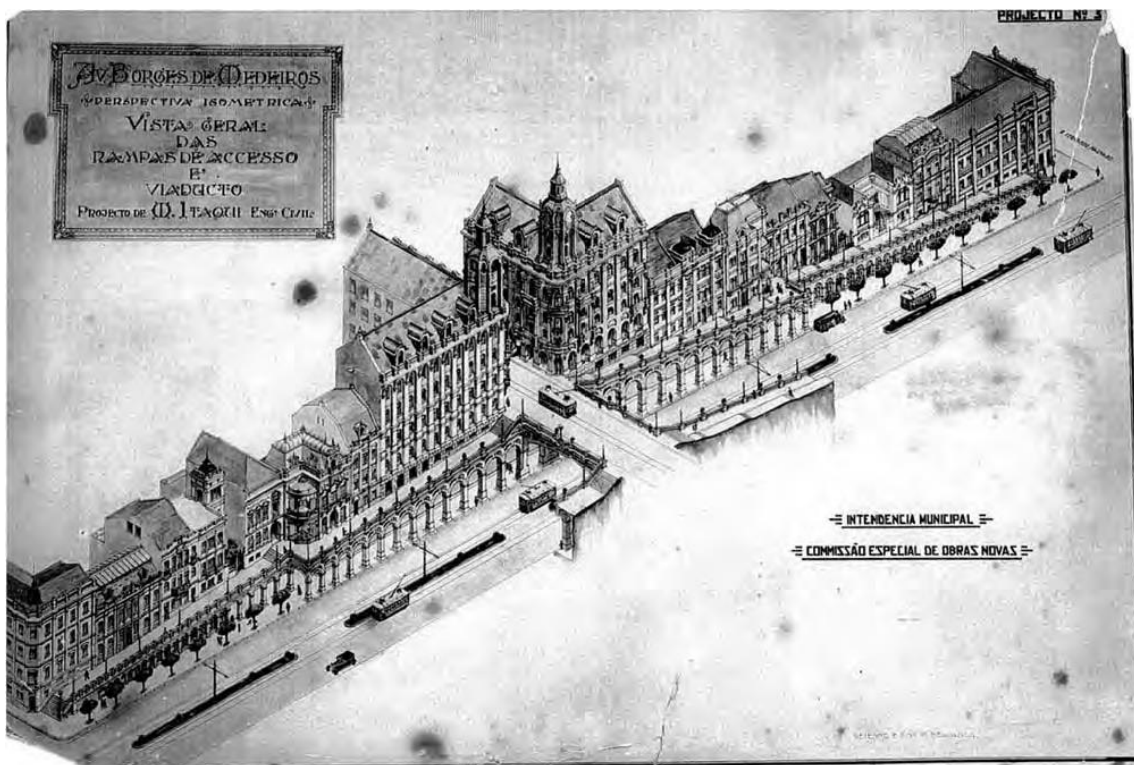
Detalhe de planta da abertura da Avenida Borges de Medeiros (1927)
